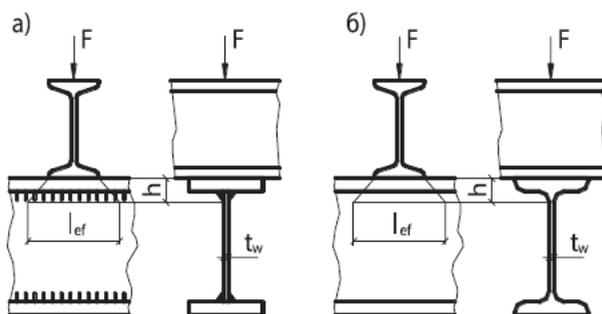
Схемы распределения сосредоточенной нагрузки на стенку балки: а) - сварная балка; б) - прокатная балка [2]
